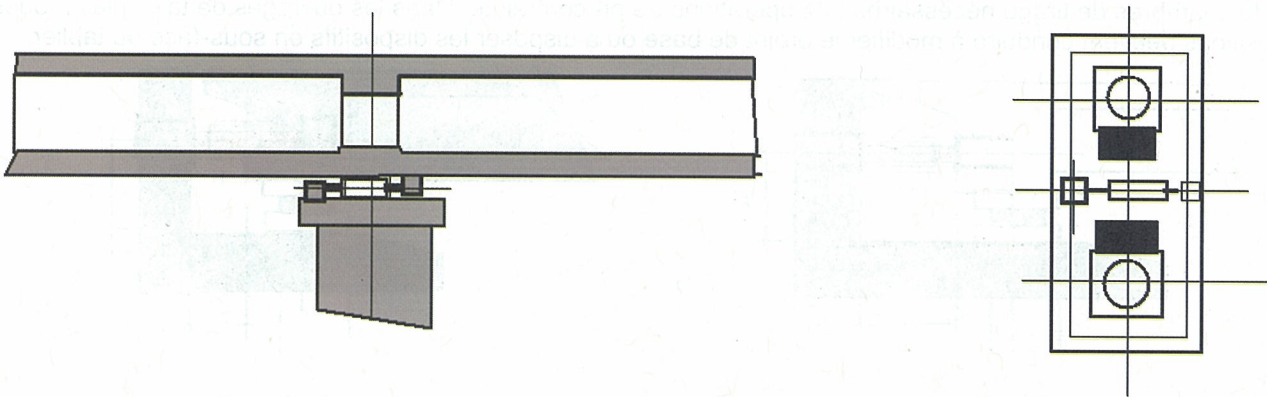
Ouvrage en béton, mise en place dans le sens longitudinal
